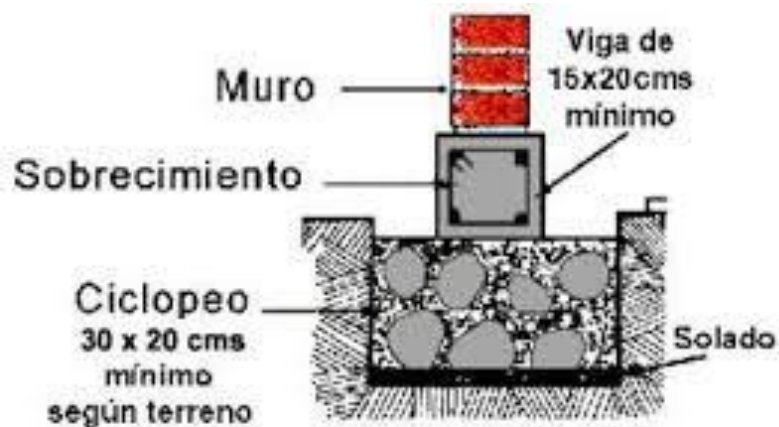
Viga de concreto en el sobre cimiento, fuente: tripod
